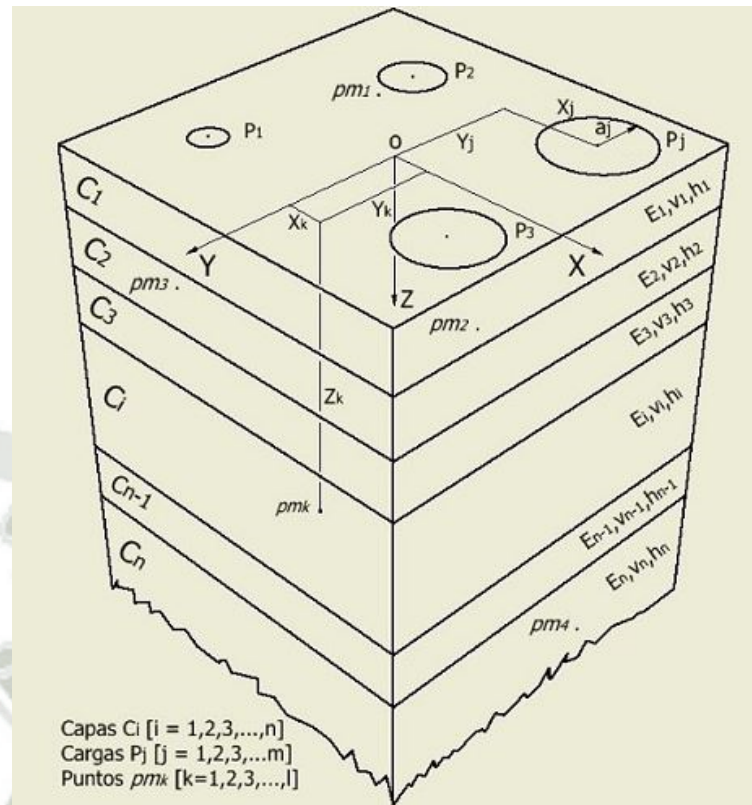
Sistema multicapa, se ejemplifica la distribución de los posibles espesores de un pavimento flexible (PITRA PAVE)
